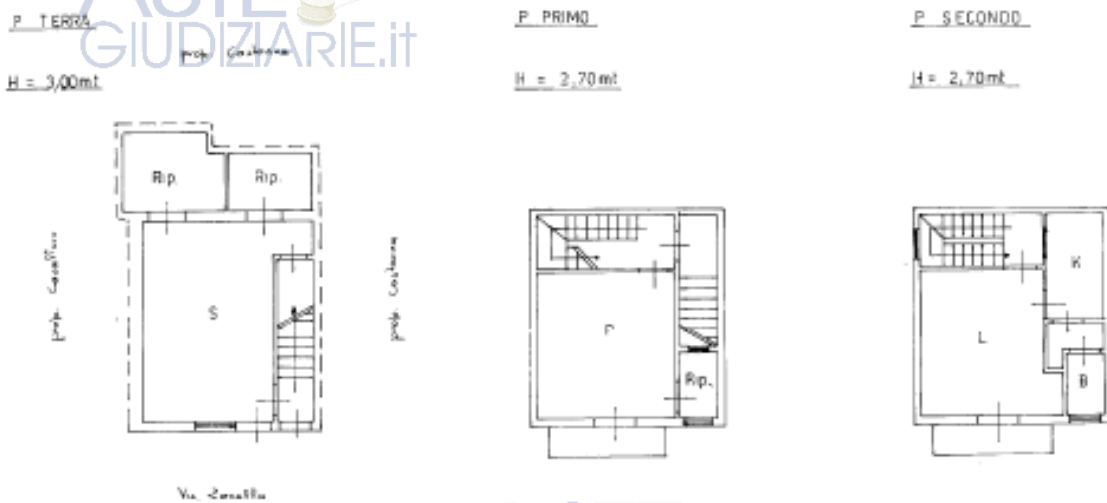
Stralcio piante catastali (Immobile piano terra, primo e secondo censito al Fg. 69, part. 13233, sub. 1)
